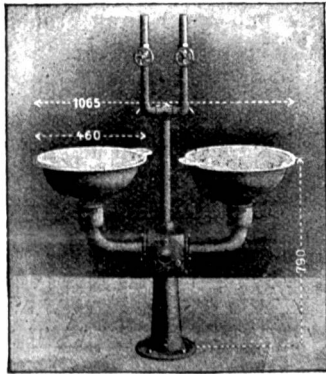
Seitenansicht einer zweiseitigen Anlage mit Becken von 400 mm Ø außen grundiert
